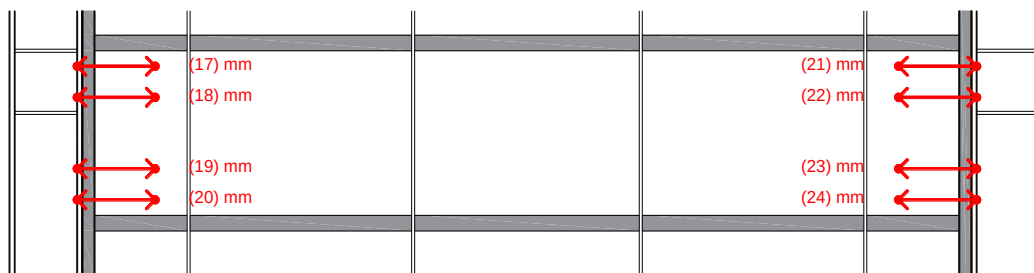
Posizionamento strumentazione da 17 a 24
